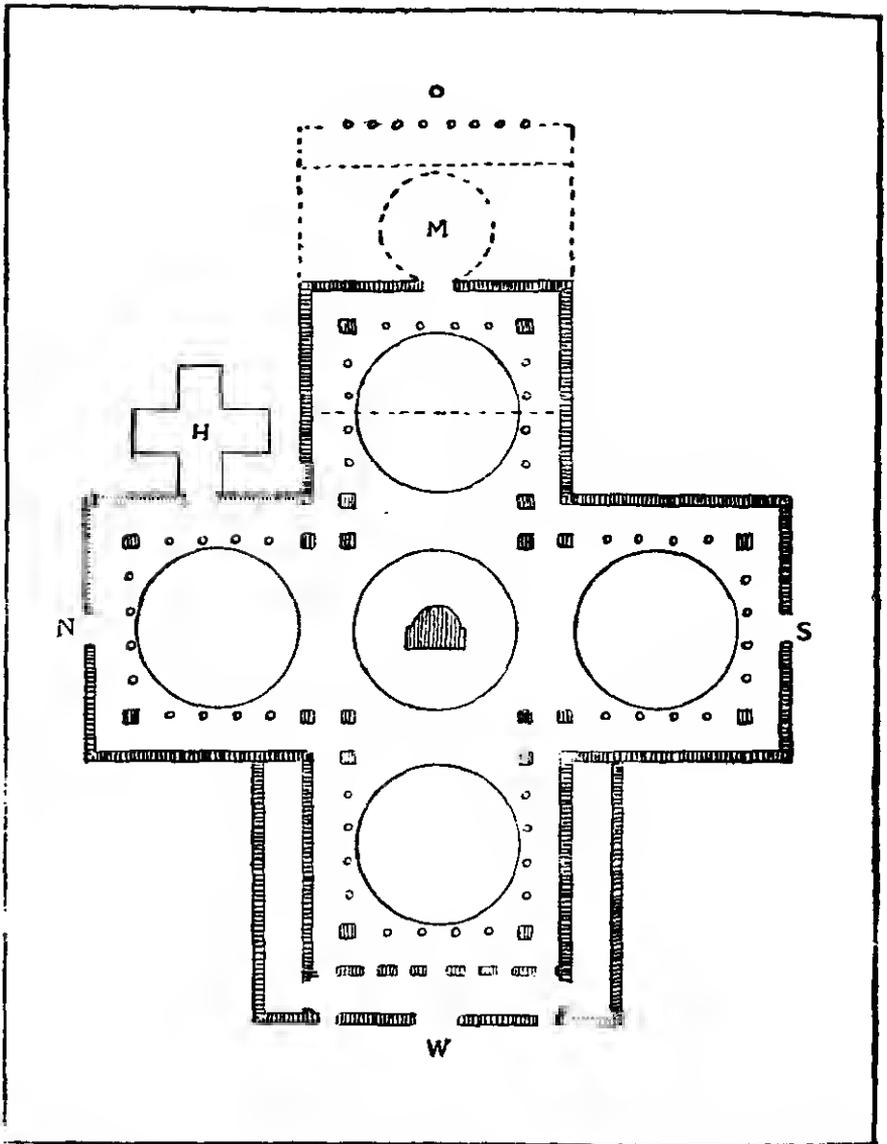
DIE APOSTELKIRCHE, REKONSTRUIERTER GRUNDRISS VON A. HEISENBERG, 1908.
